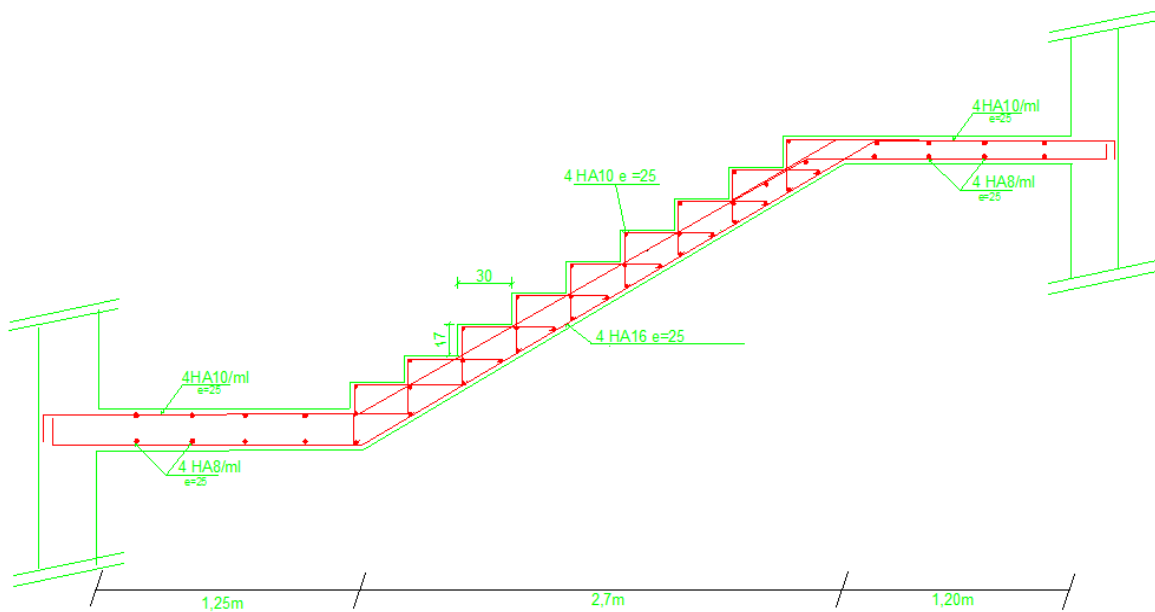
Plan de ferrailage d'escalier 3^{eme} volée
